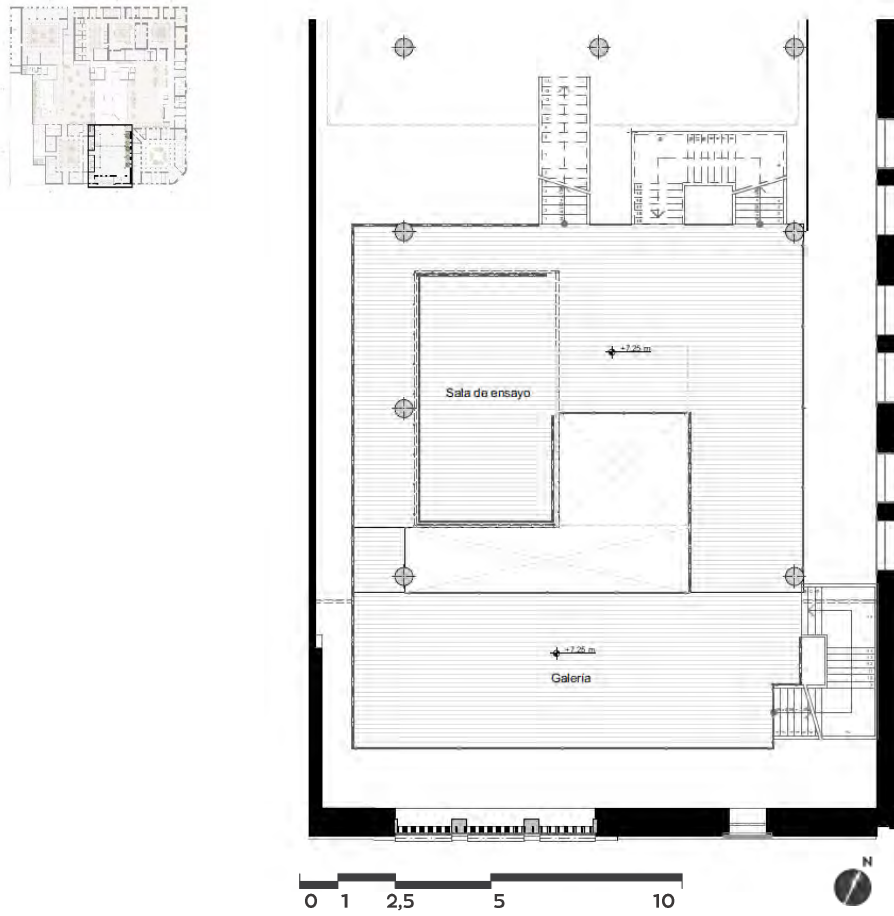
Planta Mezzanine Galería 1. Fuente: Elaboración Propia.
